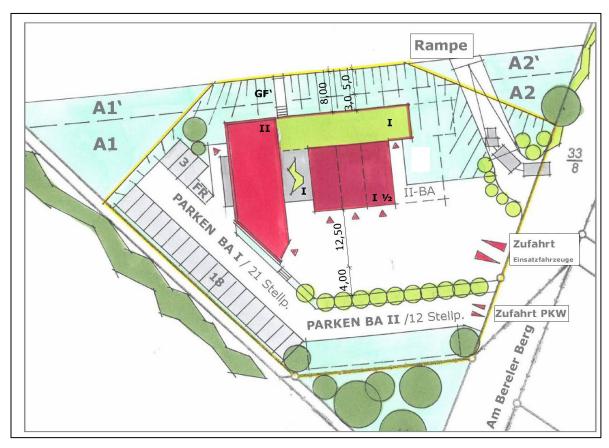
Planentwurf architekten gjh, Salzgitter, 12/2023
